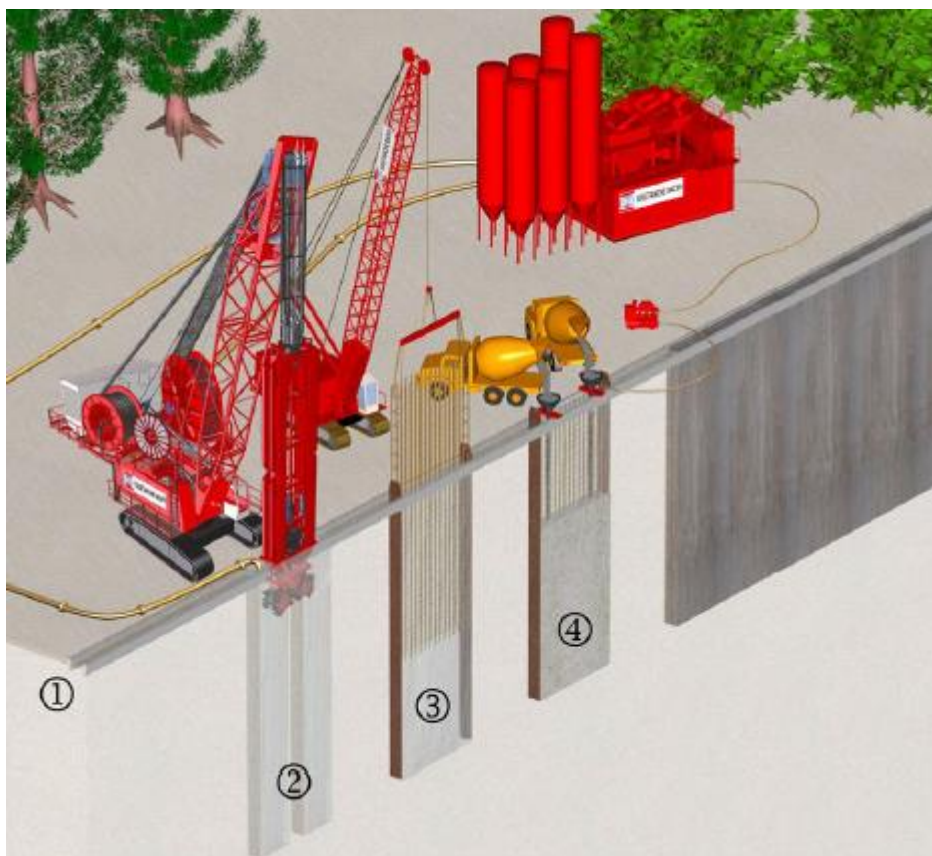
Esquema representativo da construção de uma parede moldada: 1-muro guia; 2-escavação da trincheira para o painel; 3-colocação da armadura; 4-betonagem do painel [83]
